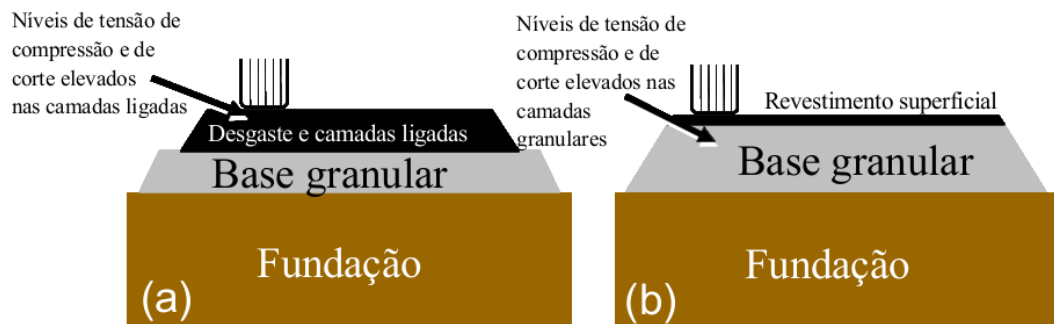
Perfil esquemático do pavimento (a) estrada de alto volume e (b) estrada de baixo volume (adaptado de Brito, 2011)
